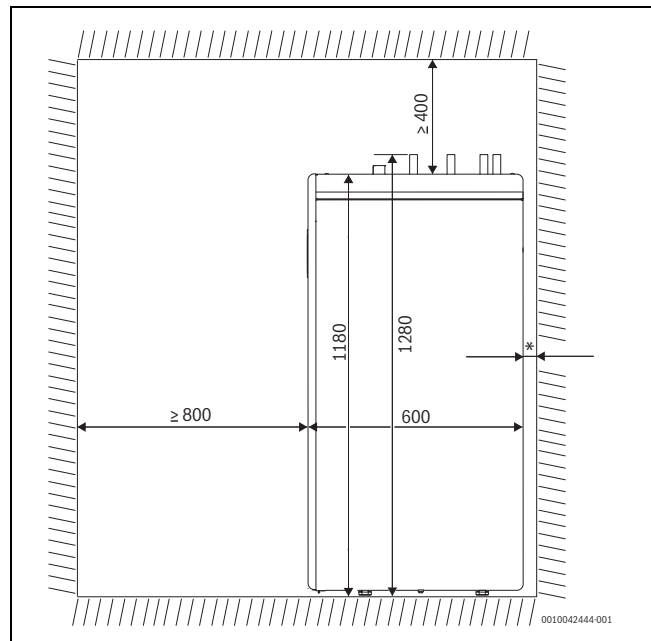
Vue latérale : dégagement minimal par rapport au côté opposé et à la face arrière du mur.
